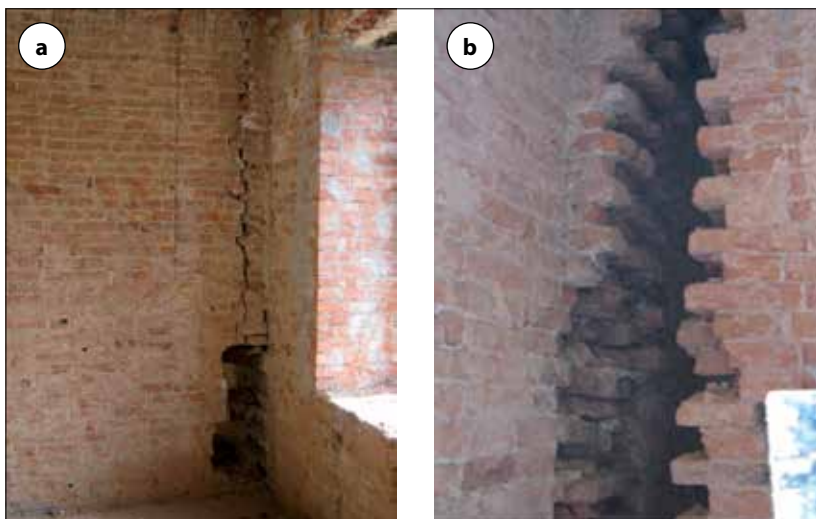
| Brak kompatybilności nowego muru z pierwotnym podczas przemurowania
